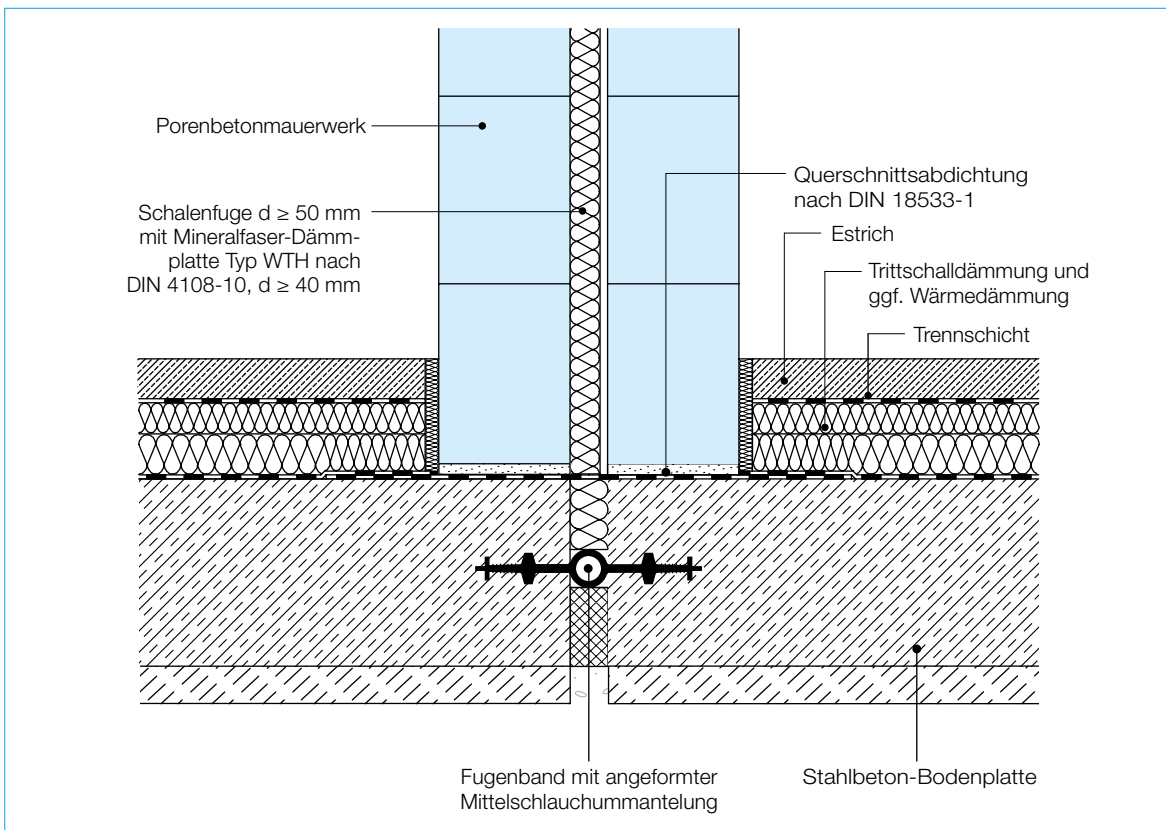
Zweischalige Haustrennwand aus Porenbetonmauerwerk – Anschluss an getrennte Bodenplatte
